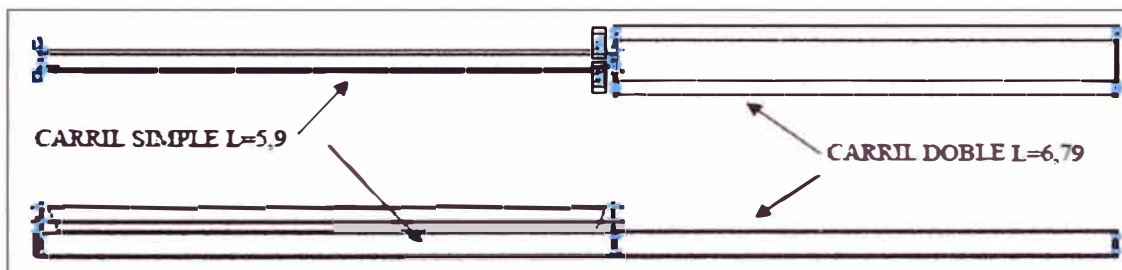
Planta y Elevación del Carril Doble L=5.9m conectado a Carril Simple L=6.79m.
